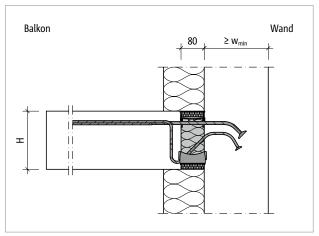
Schöck Isokorb® T Typ KL-O: Wandanschluss nach unten bei Außendämmung
